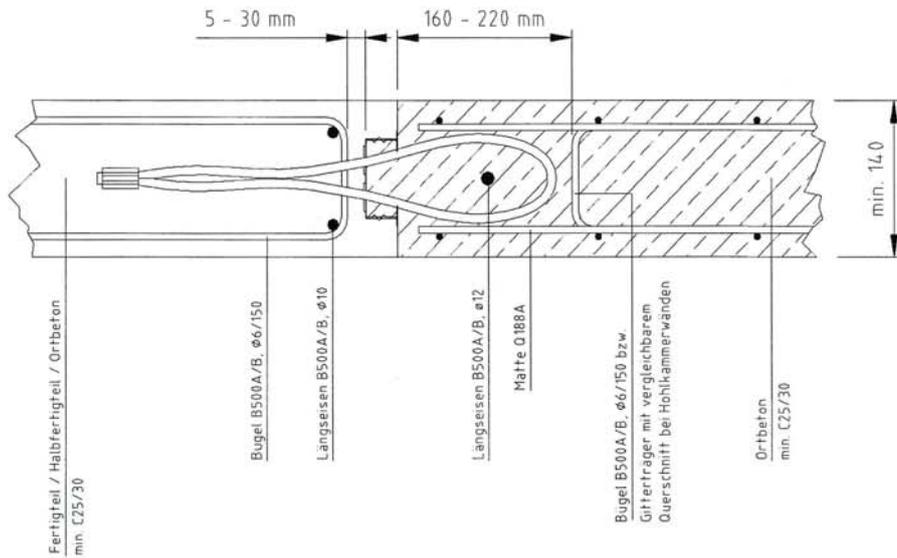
Querschnitt Ortbetonergänzung, Bewehrung
